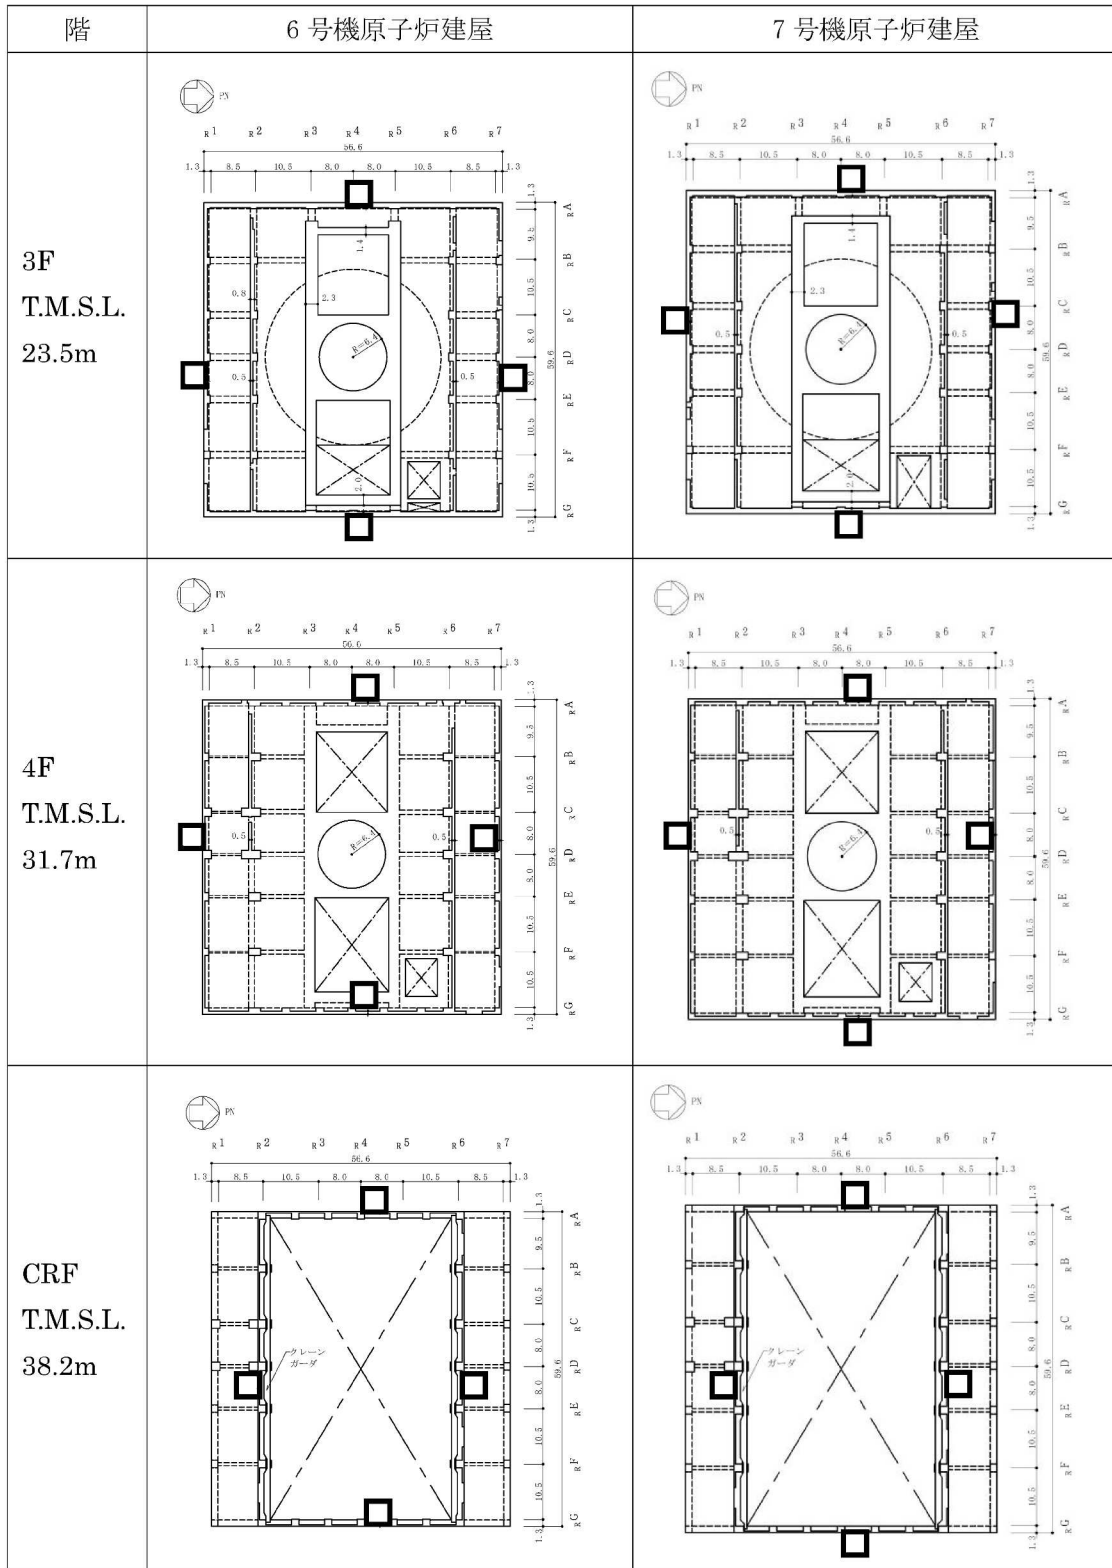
6号機原子炉建屋及び7号機原子炉建屋の概略平面図(4/4)(単位:m)
